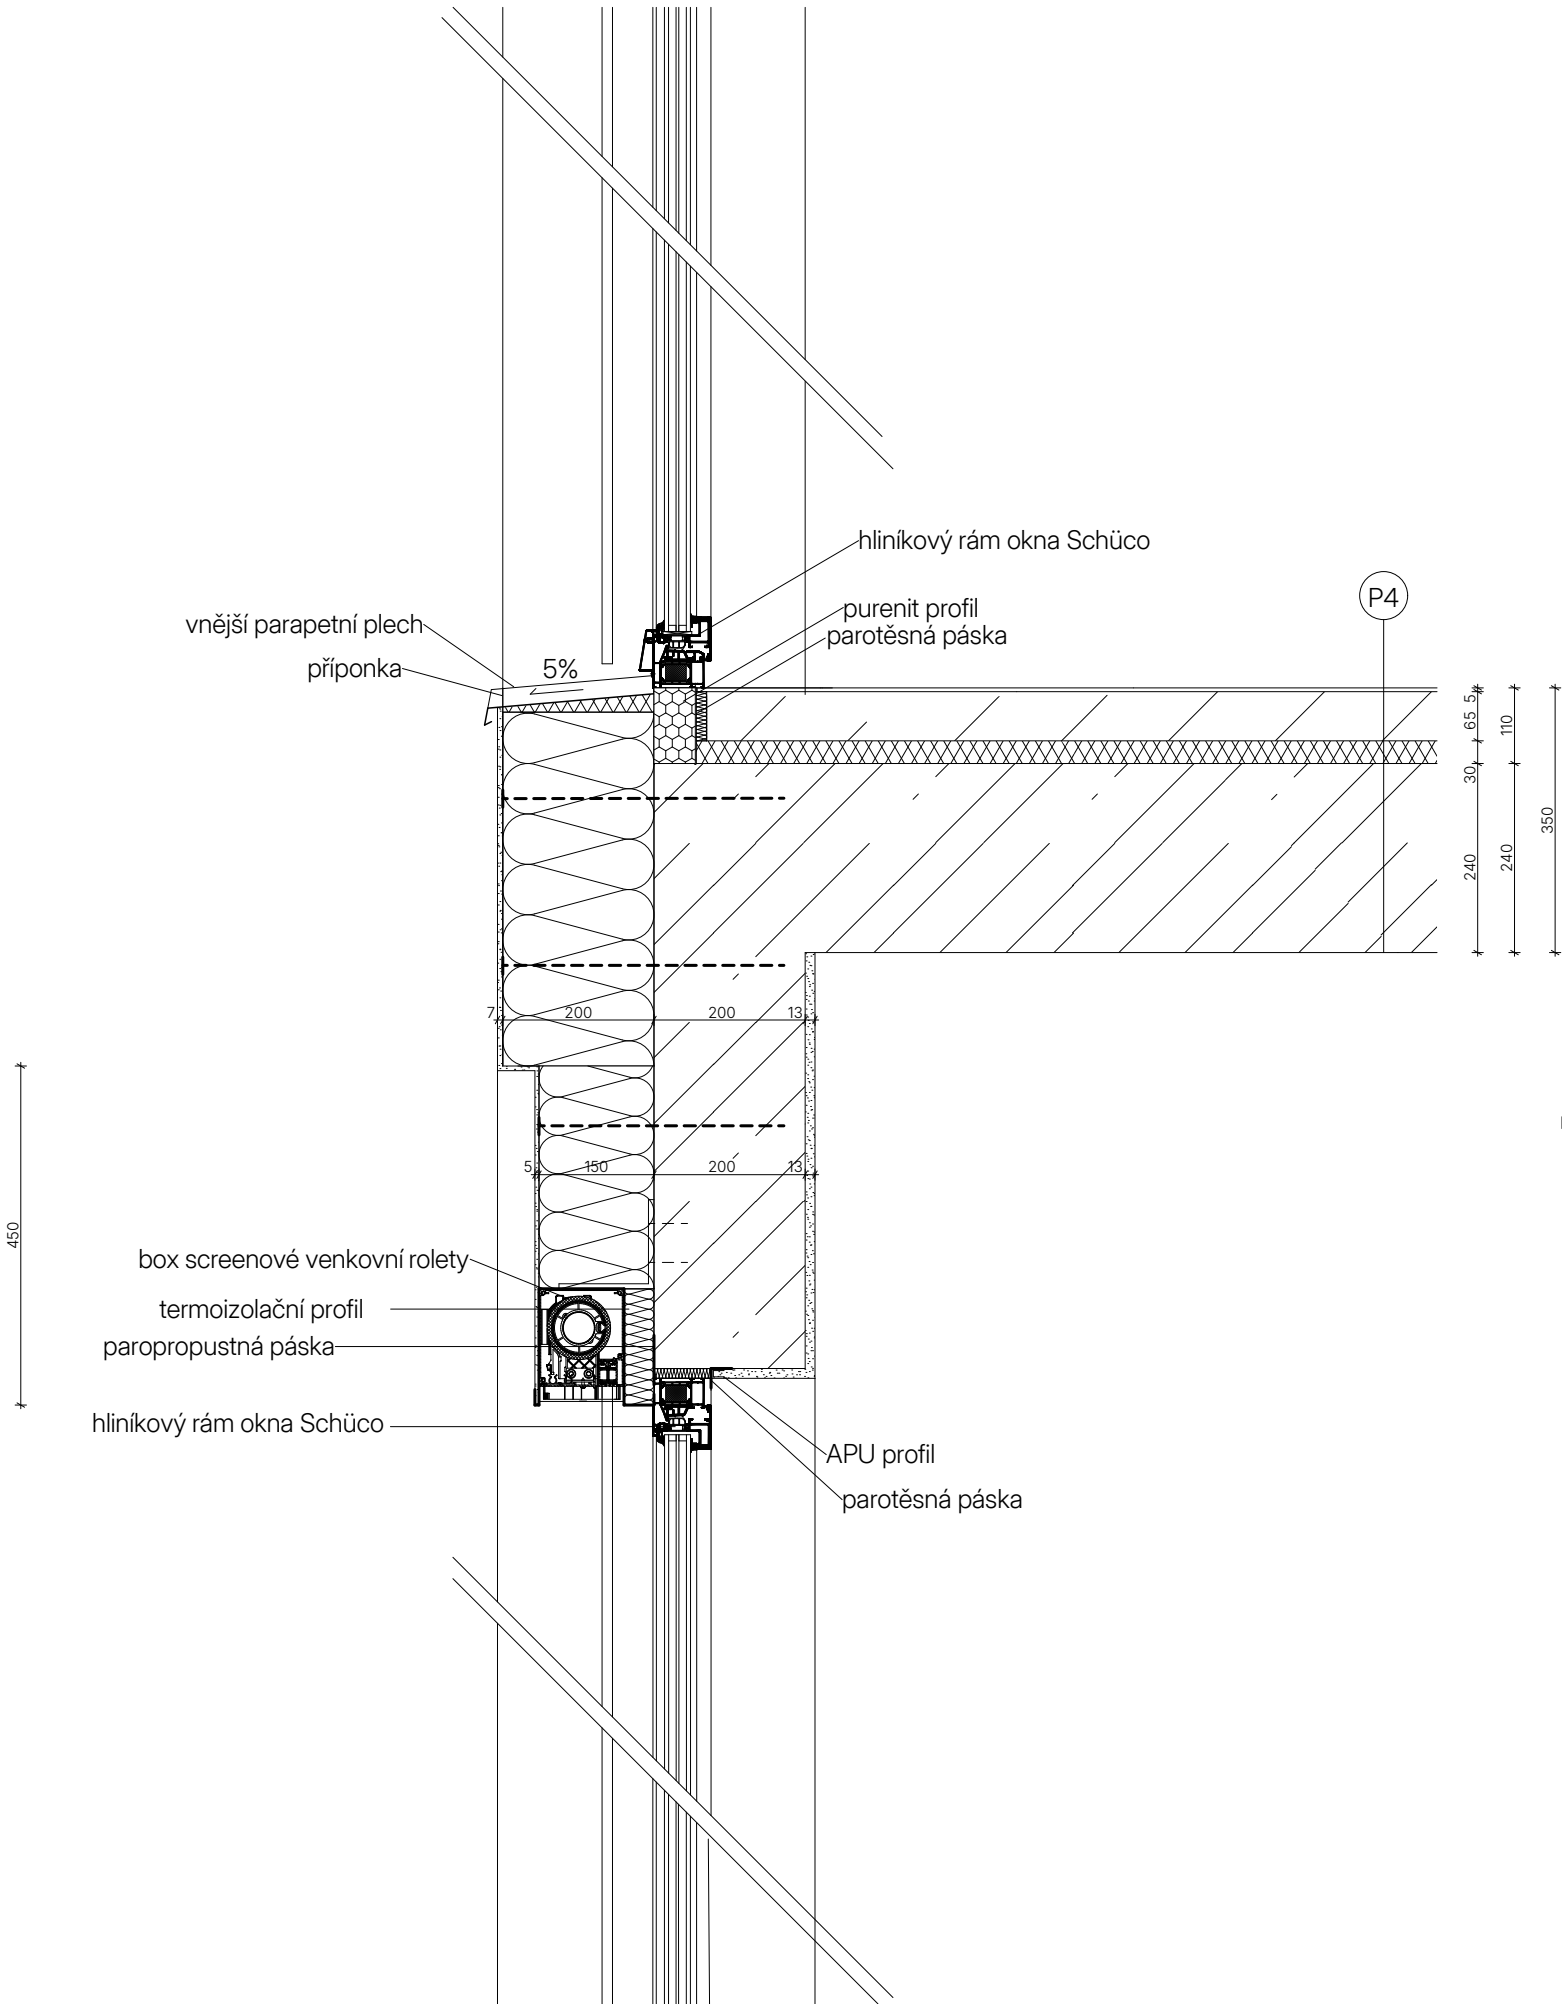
DETAIL ATIKY, NADPRAŽÍ A PARAPETU
